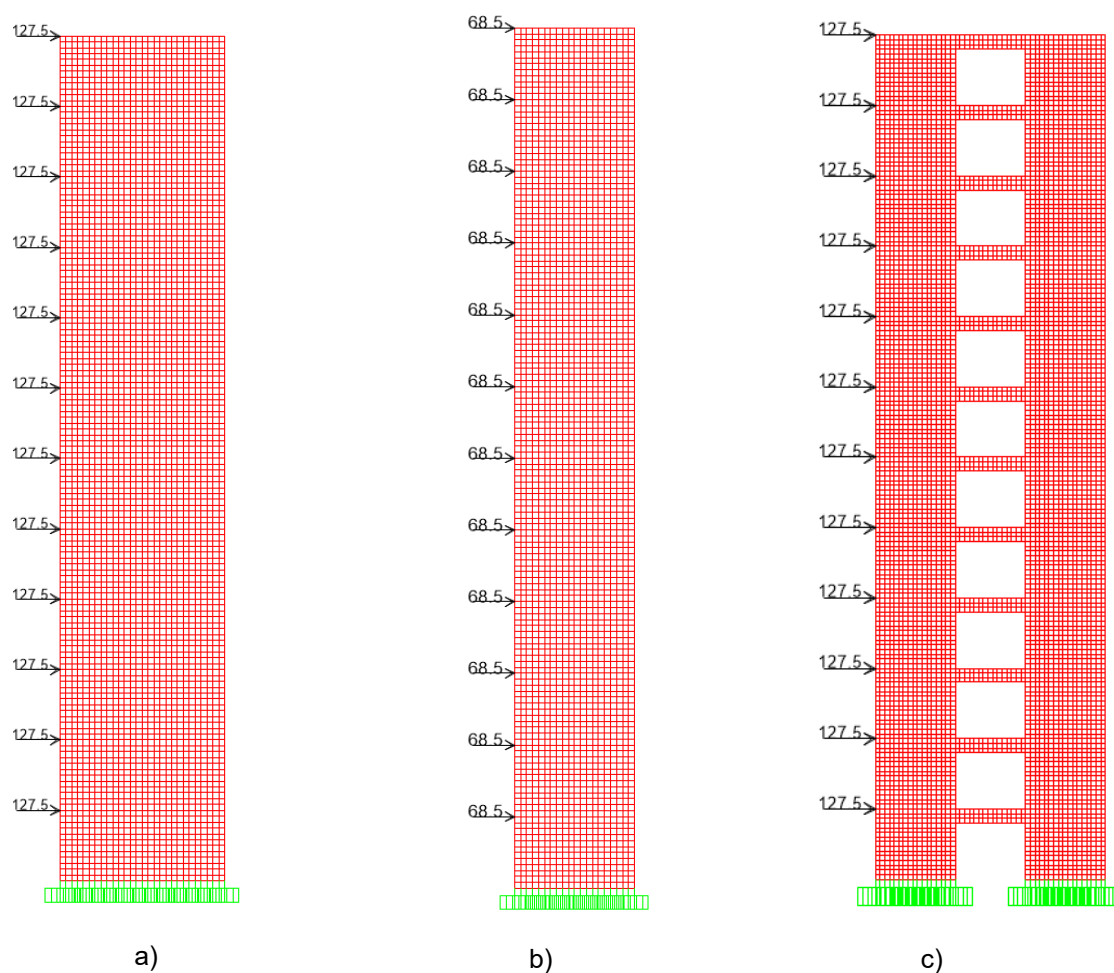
Modelo estrutural a) da parede dúctil isolada 7 metros; b) da parede dúctil isolada 5 metros; c) da parede acoplada com rigidez semelhante a uma parede de 7 metros
